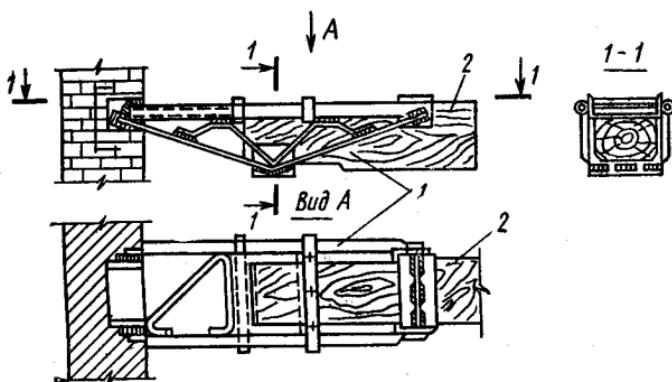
Усиление балок перекрытия прутковыми протезами:
